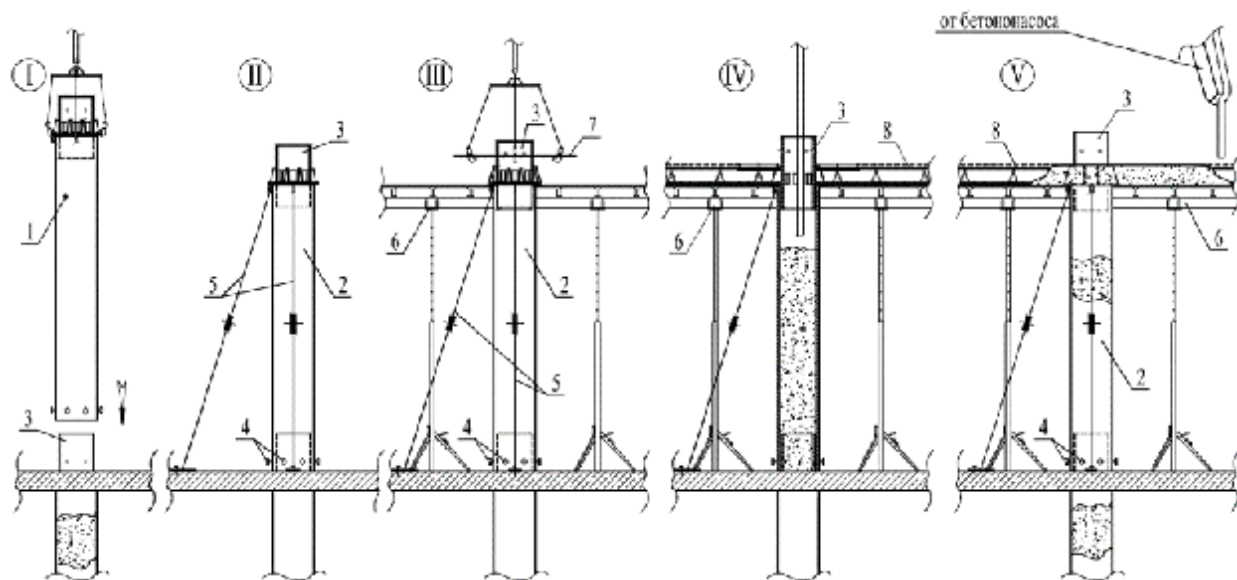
Технологическая схема возведения несущих конструкций каркаса здания с колоннами из трубобетона
